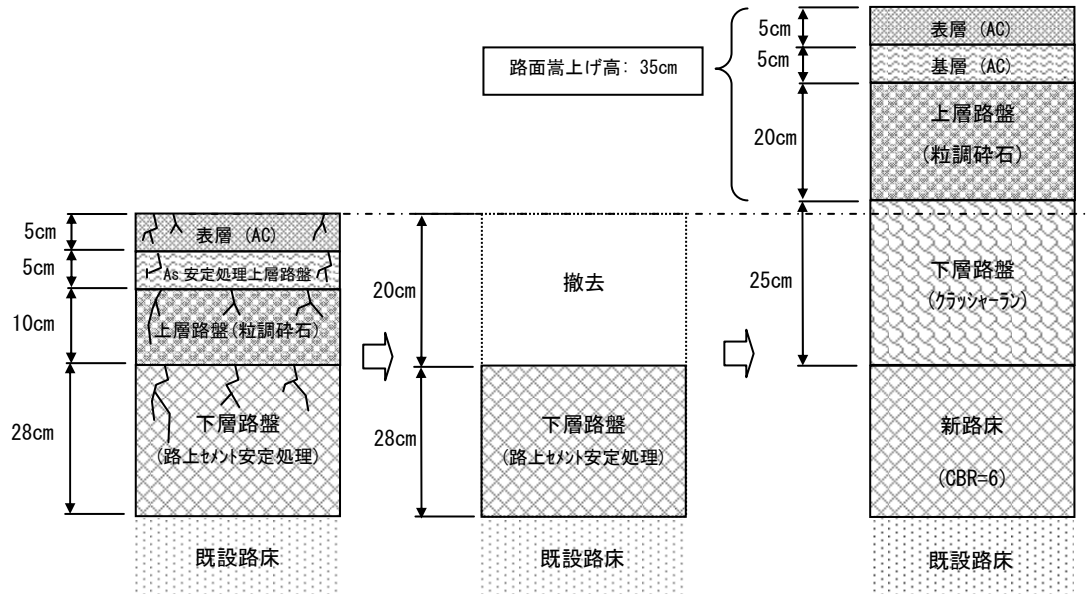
改修区間-1 地方部舗装打換工事の構造図（ひび割れ率+補修率>15%、新たな路盤材料）
